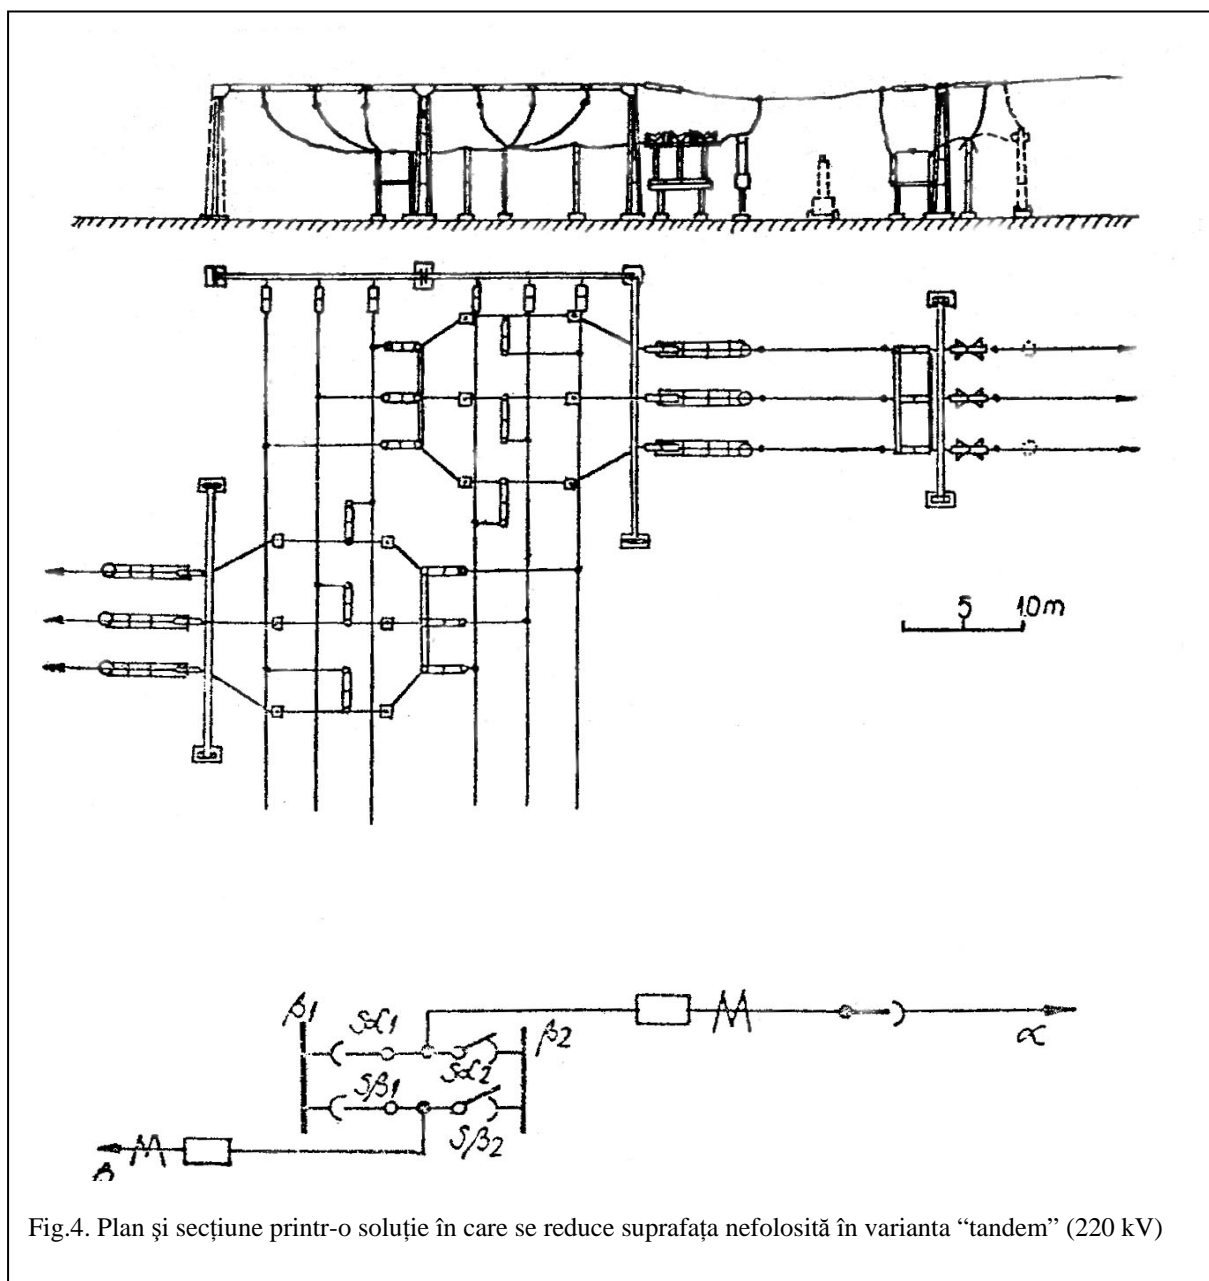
Plan și secțiune printr-o soluție în care se reduce suprafața nefolosită în varianta “tandem” (220 kV)
